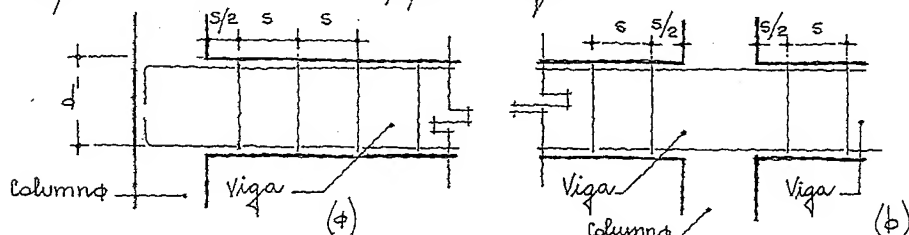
Separación de estribos a ambos lados del apoyo, (b).
